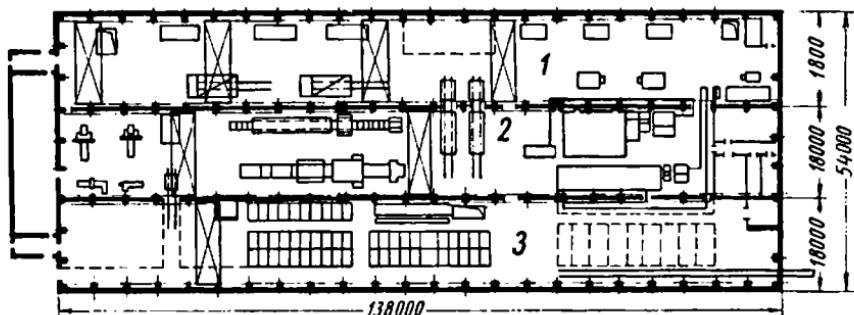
План обрубного корпуса на годовой выпуск 35 000—40 000 т отливок
